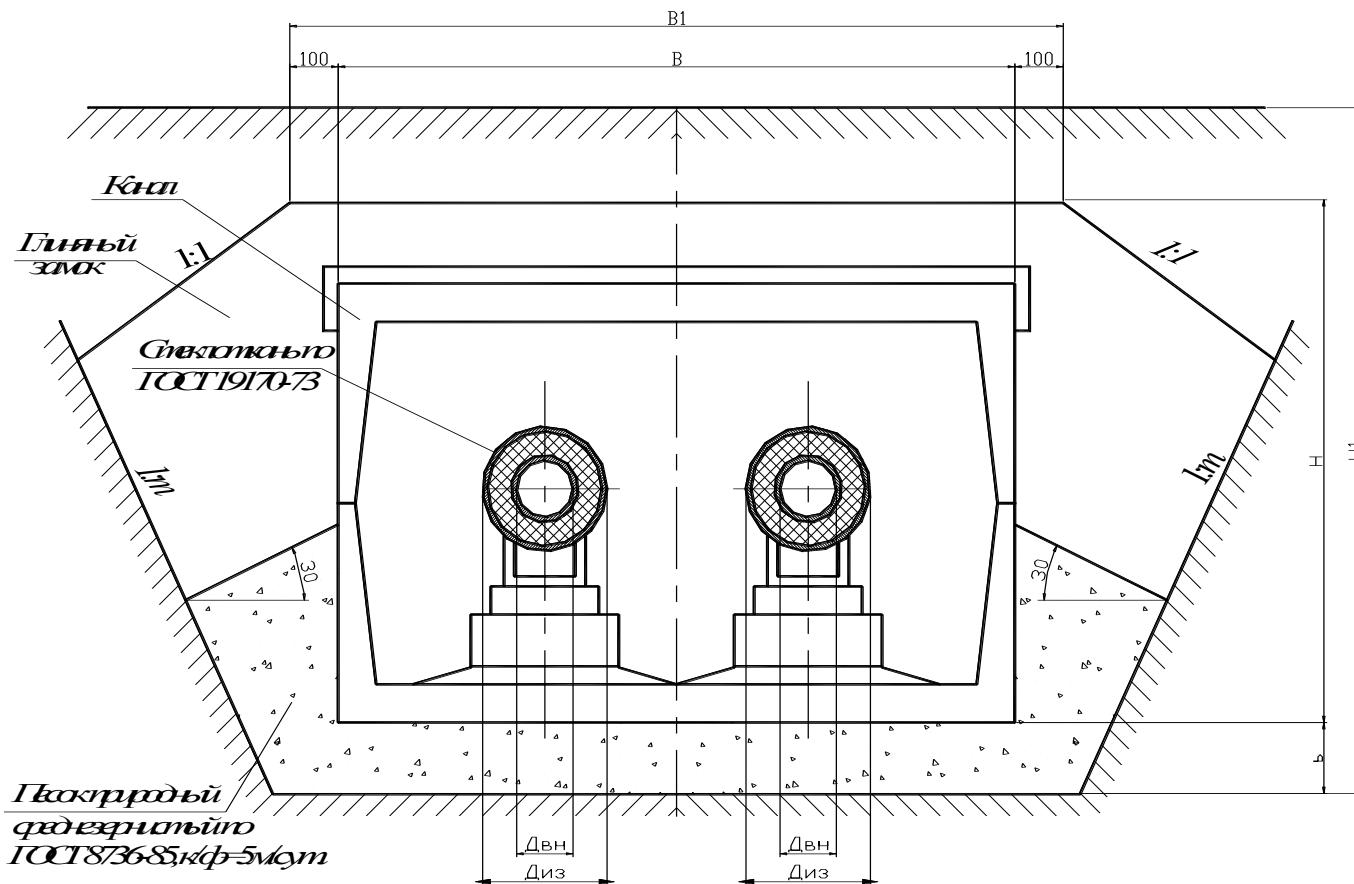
Конструкция сопряжения бесканальной прокладки с канальным участком. Поперечный разрез.
